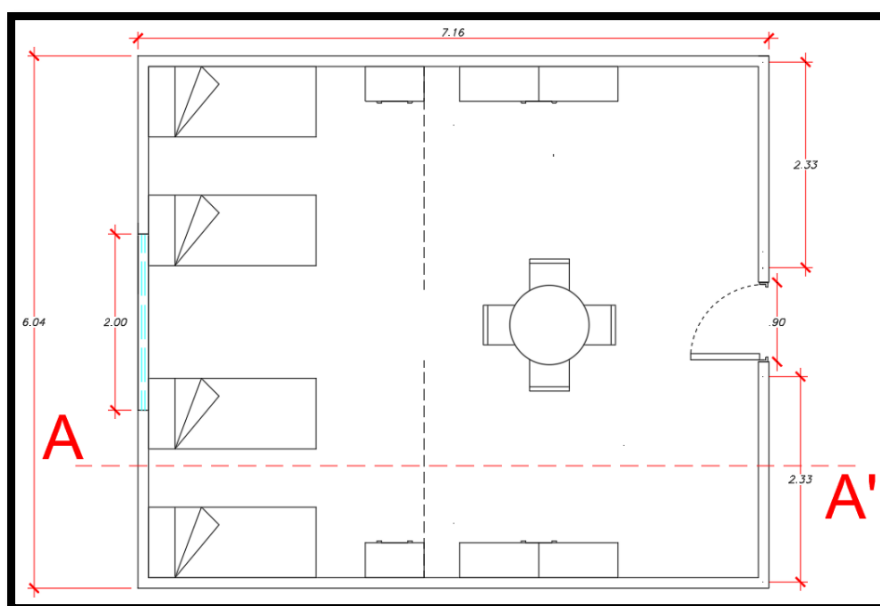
Distribución Módulo Temporal Tipo "B"- Vista Planta
